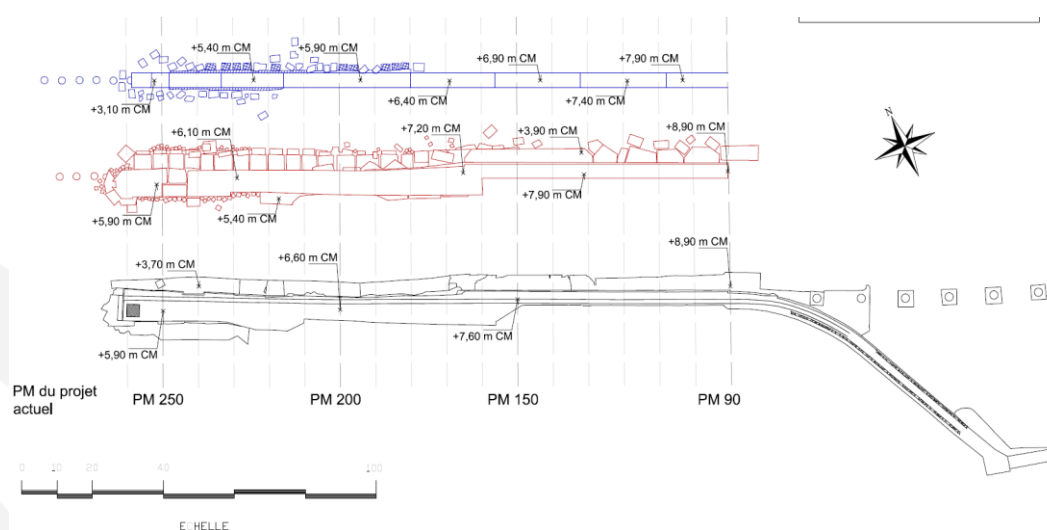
Vues en plan de la jetée de 1900 à aujourd'hui
